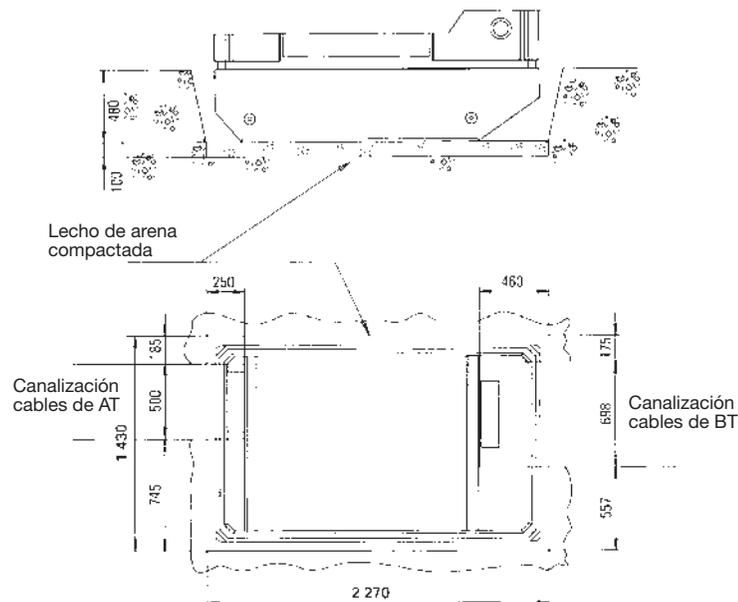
Excavación y dimensiones de un CT prefabricado.
